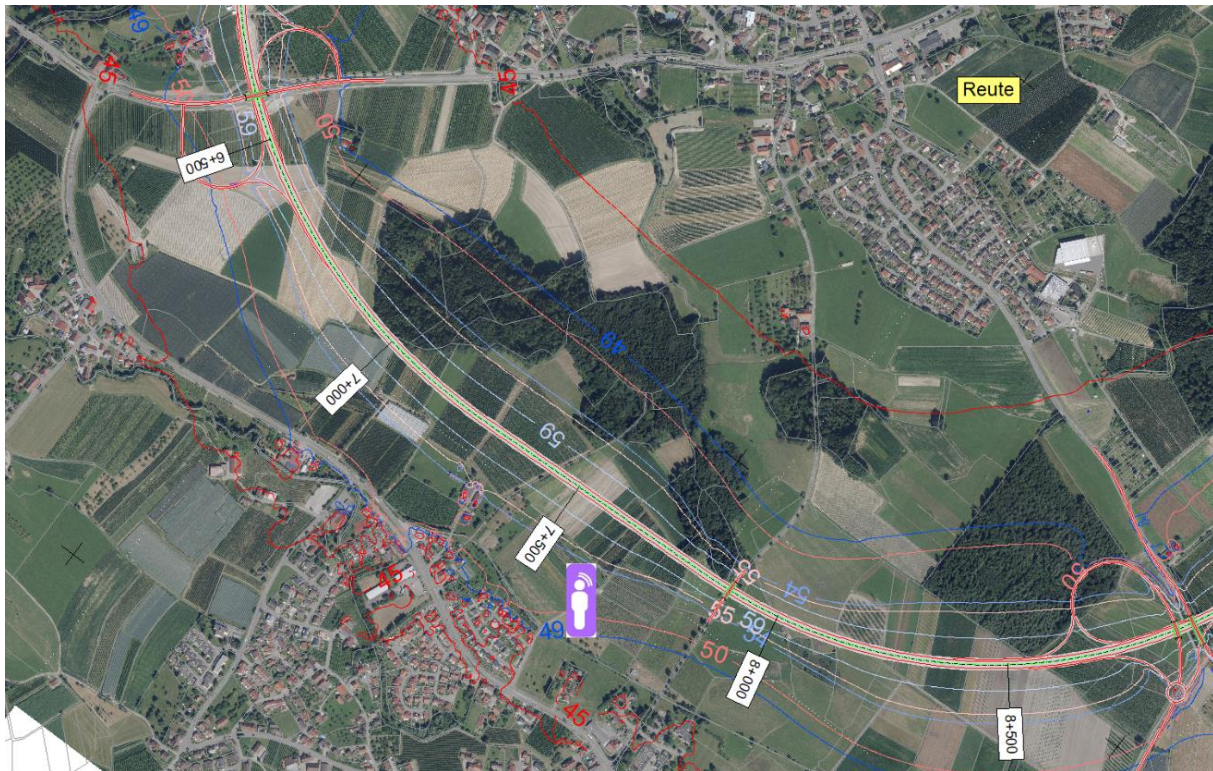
Planausschnitt Unterlage 21.4, Plan Ostvariante bei Walchesreute, Bau-km 6+500-8+500 mit Isophonen
